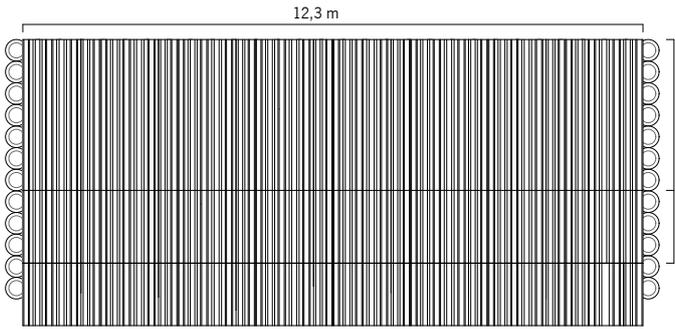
Planta da chapa metálica, lacada, ondulada - cobertura - 1/150
